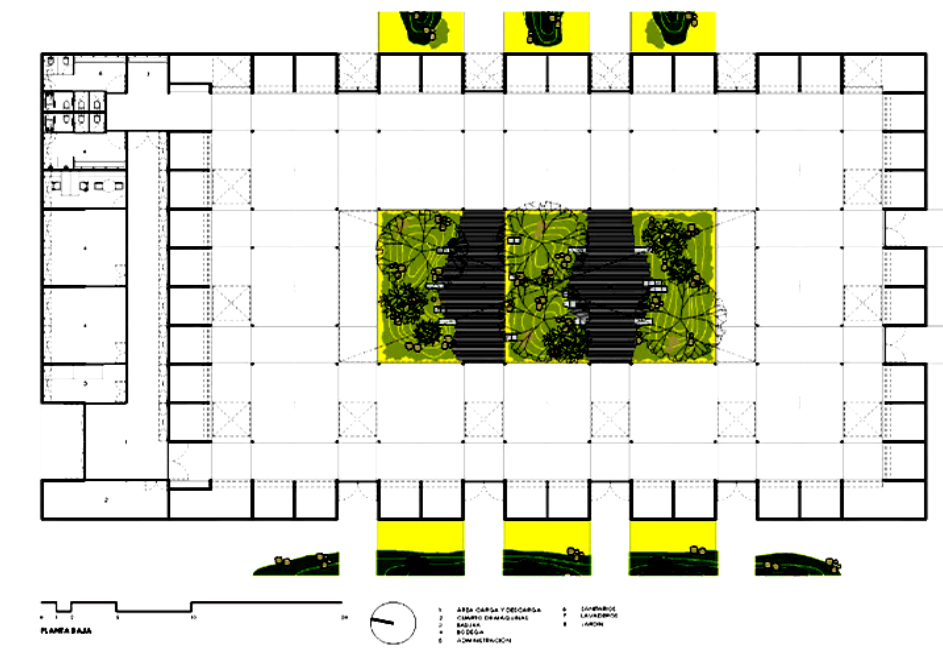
Planta arquitectónica y ubicación de locales de comercio
